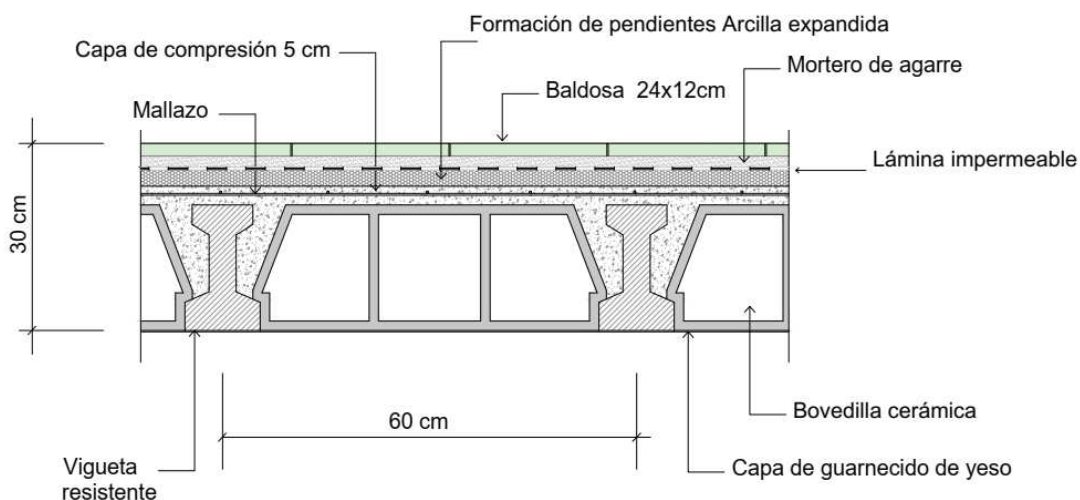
Detalle sección cubierta no transitable. Fuente propia programa AutoCAD
